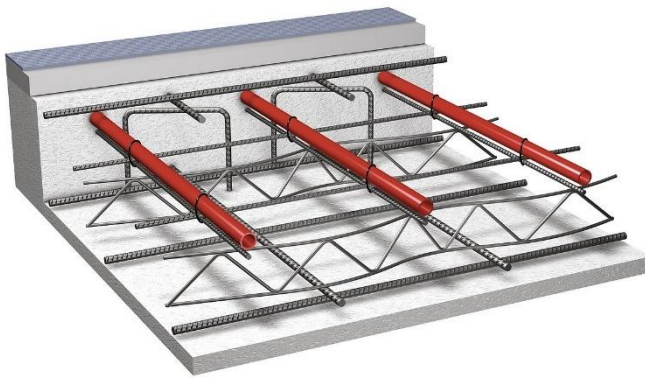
Schnitt durch eine Betondecke mit Betonkerntemperierung (Quelle: (REHAU Industries SE & Co. KG, 2022))
